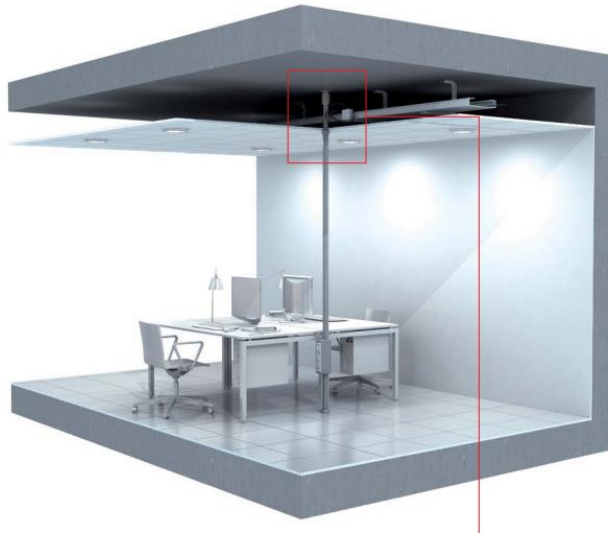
Ejemplo de falso techo y columnas para cableado.
